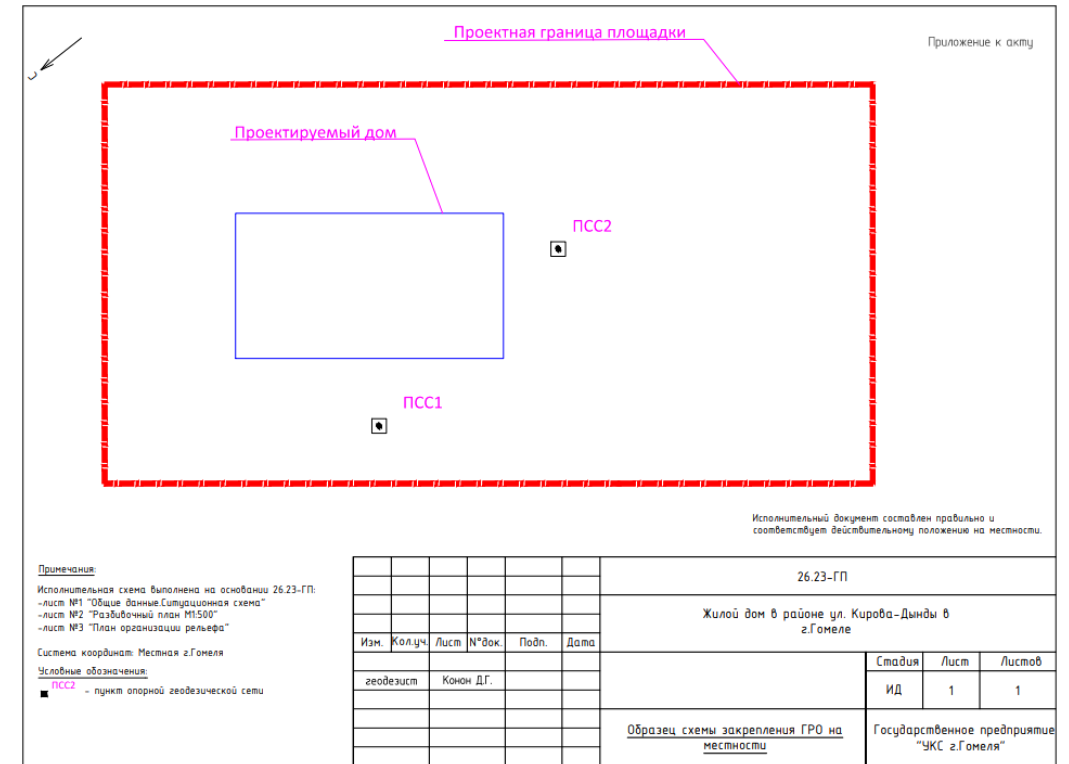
Схема закрепления геодезической разбивочной основы на строительной площадке
